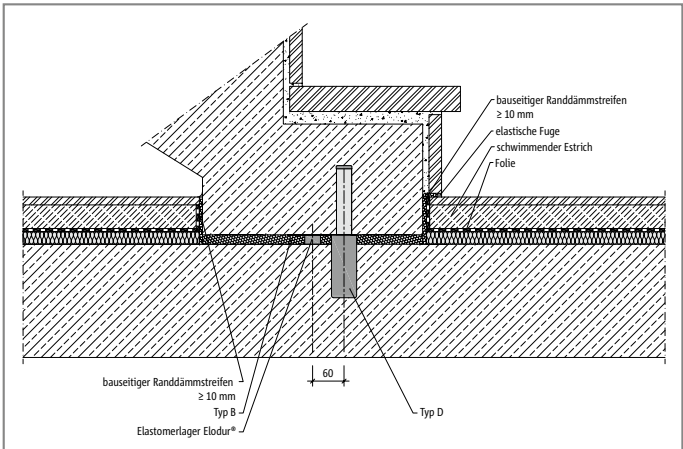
Schöck Tronsole® Typ B + Typ D: Alternative Installation
